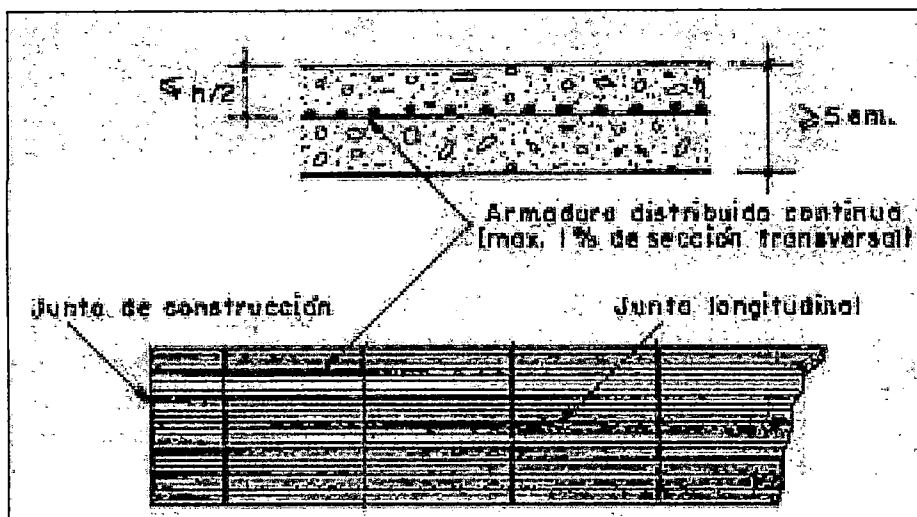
Sección del pavimento de concreto hidráulico con refuerzo continuo
